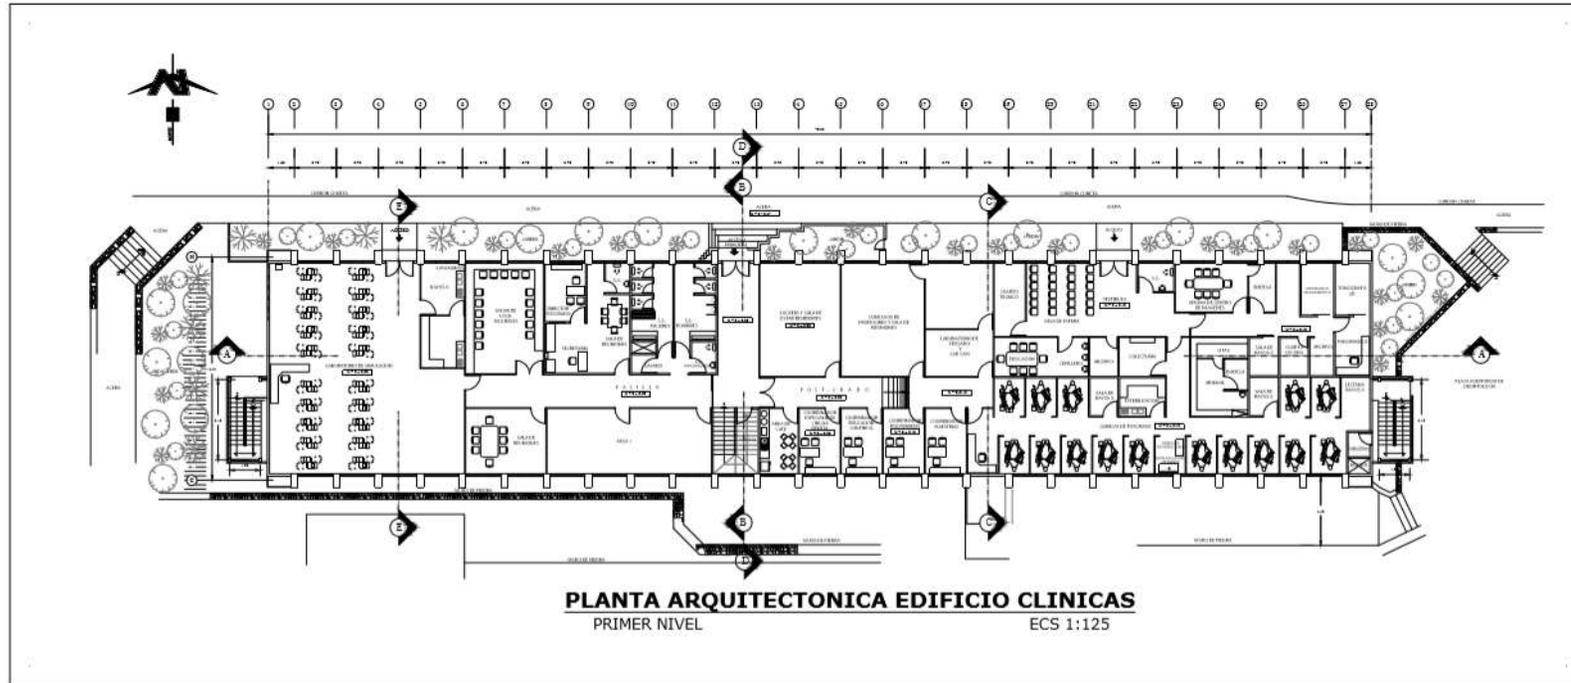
Plano arquitectónico 1er nivel clínicas
